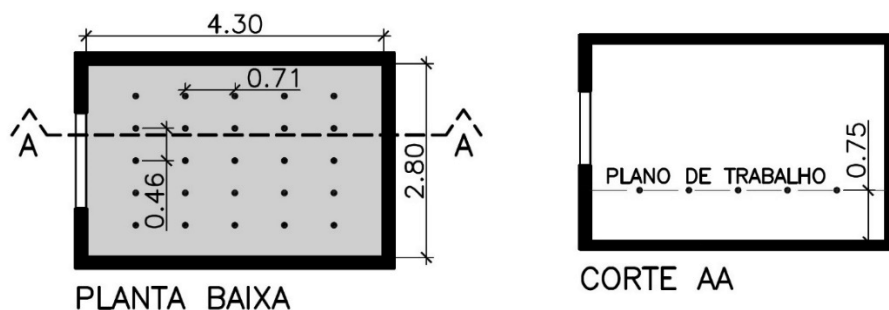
Planta baixa e corte AA indicando a malha de pontos para medição de iluminância.
